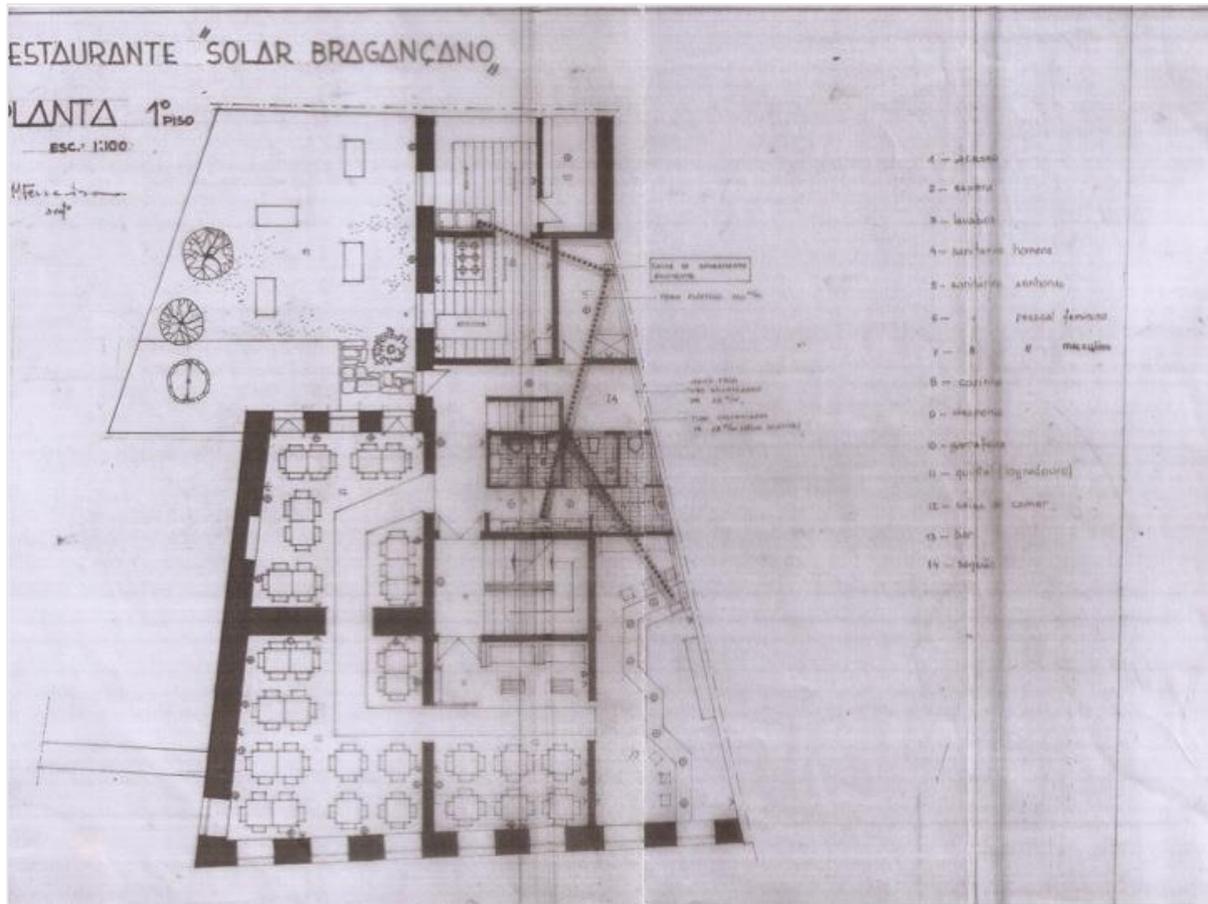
Planta de proposta de alteração 1984 - Arq. Manuel Ferreira.
